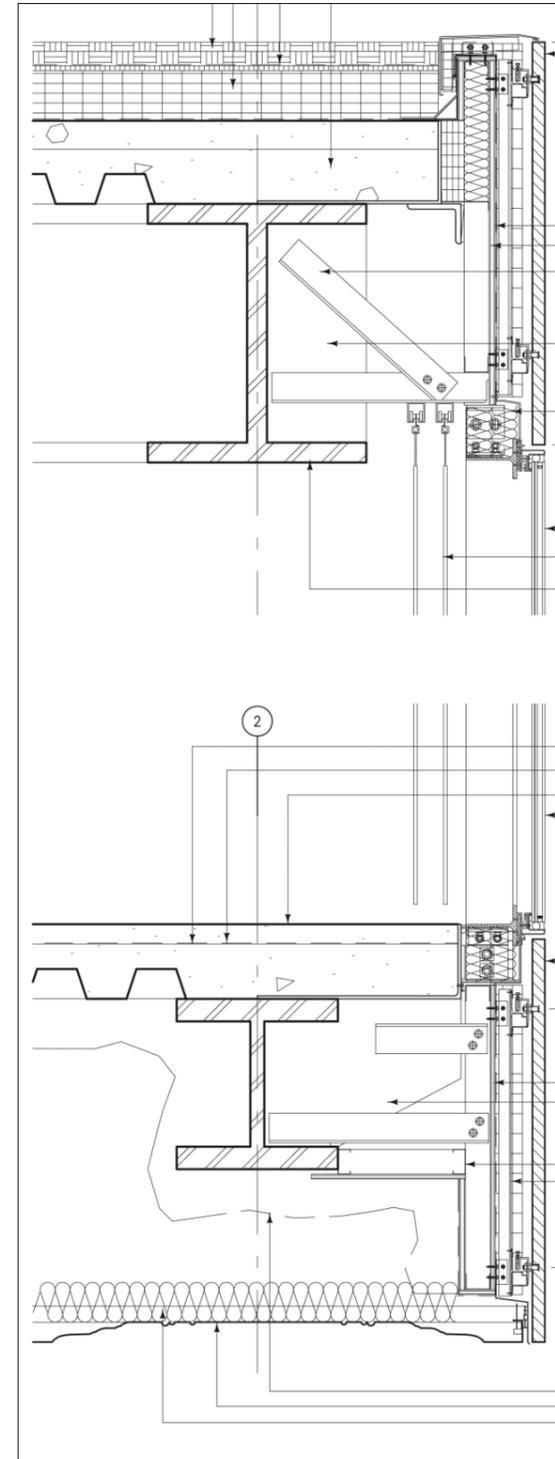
Detalle de la fachada. Ménsulas de soporte de piedra y muros cortina
